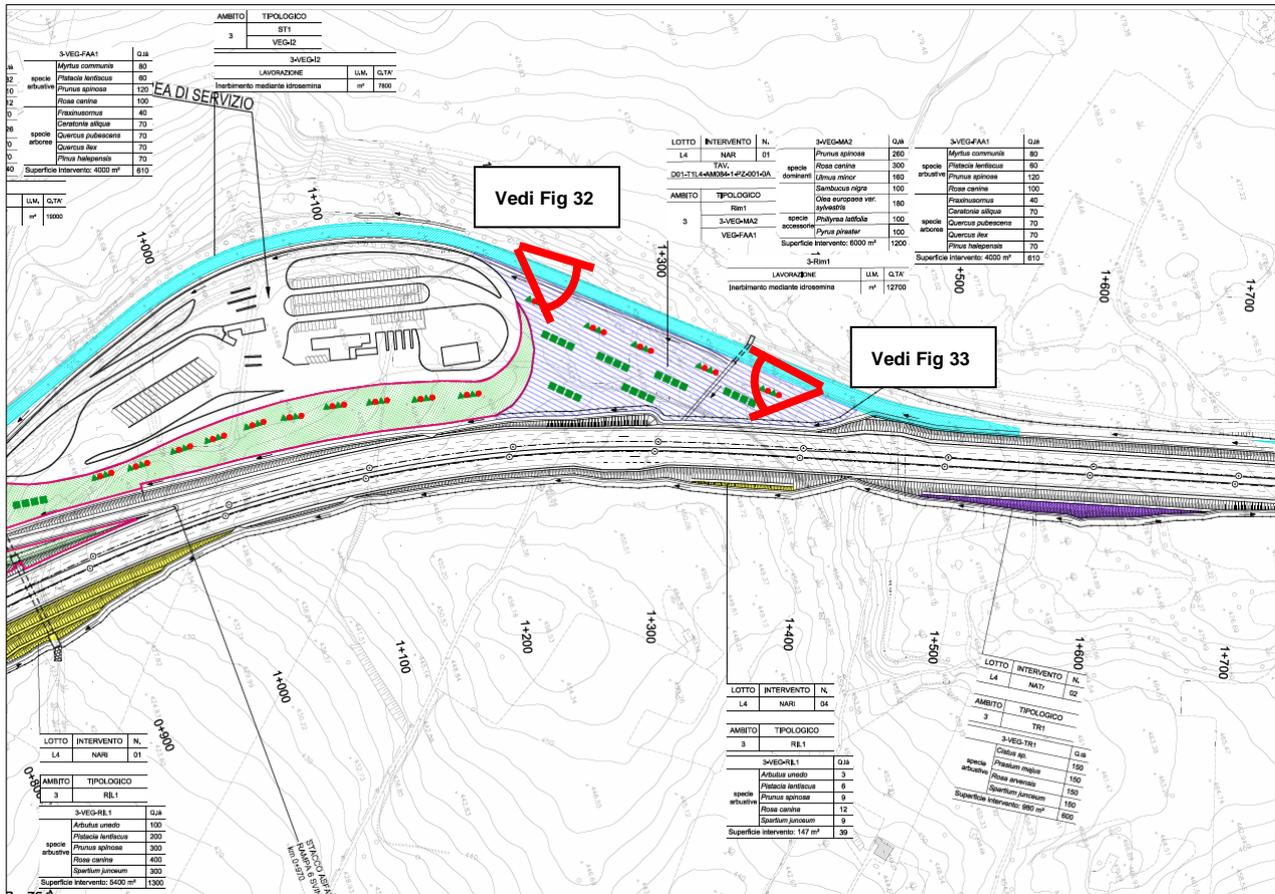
Stralcio planimetrico dell'intervento di naturalizzazione dell'area degradata del Lotto 4 da km 1+200 a km 1+450
